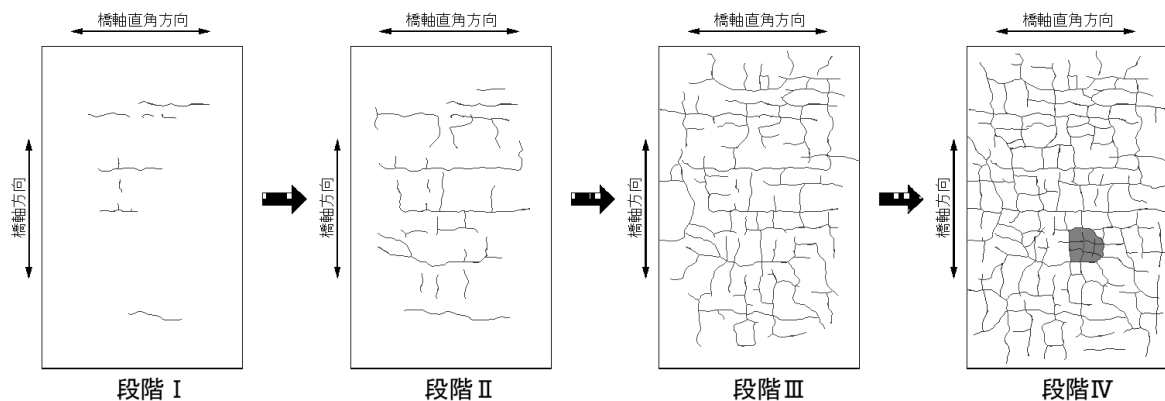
コンクリート床版（下面）のひび割れ概要図
